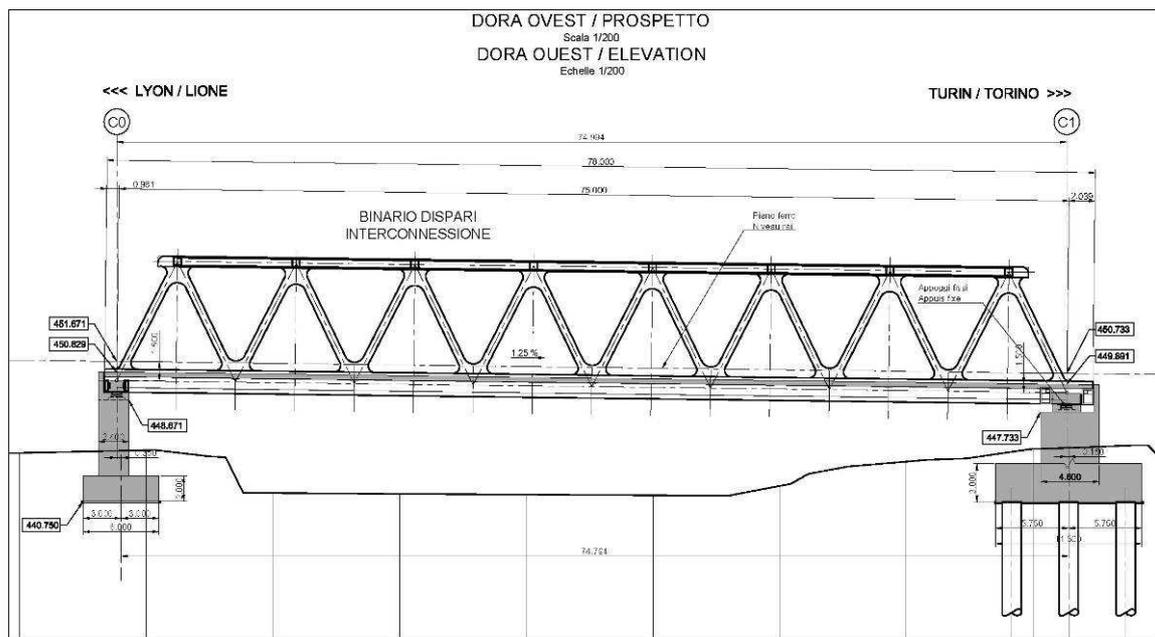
Prospetto ponti Dora est e Dora ovest a Bussoleno
